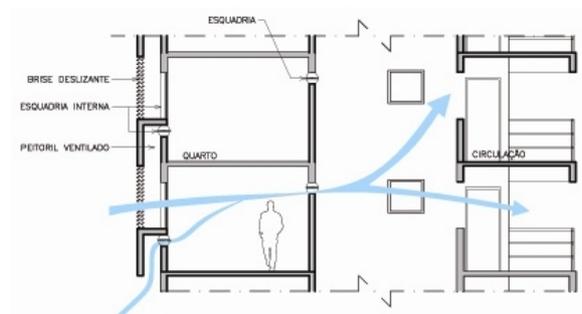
Secção de corte esquemático do Bloco 1. Fonte: FANTICELE, 2008.
